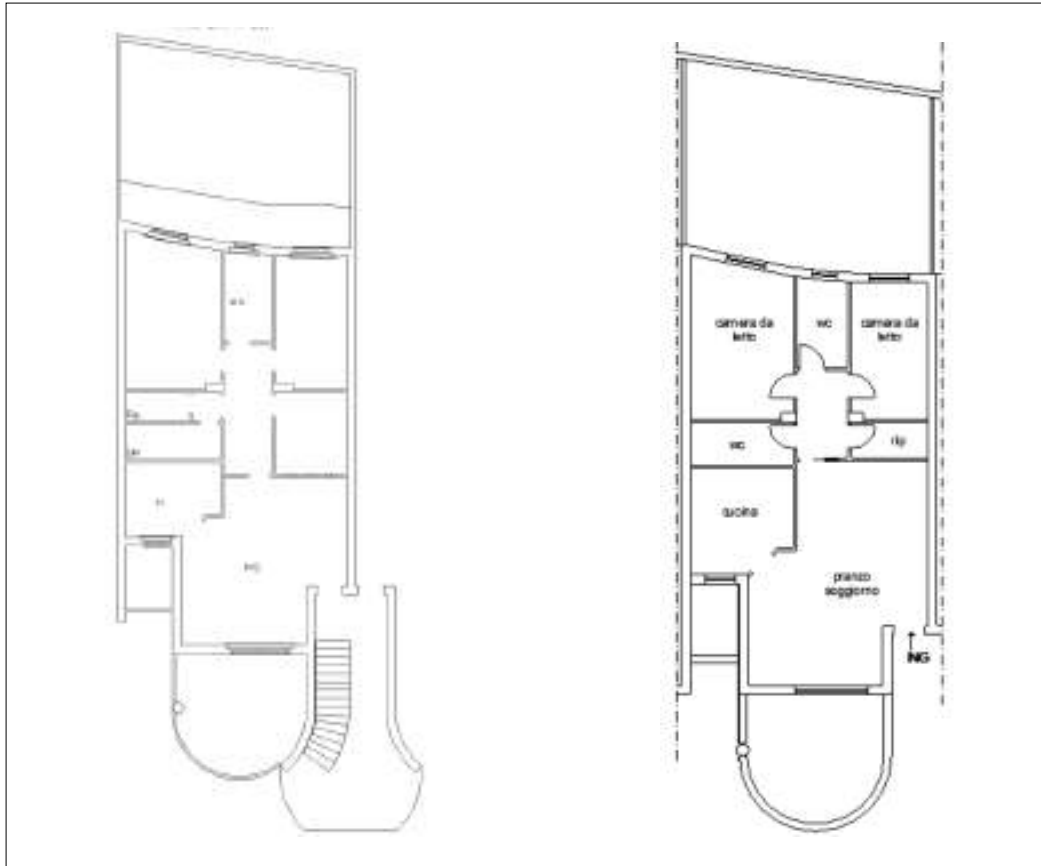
Planimetria catastale dell'appartamento sub 44 e rilievo stato di fatto
